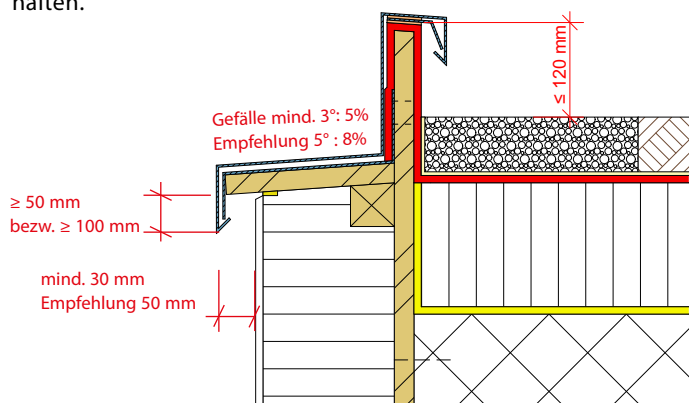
Dachrandabschluss, Entwässerung nach Aussen
